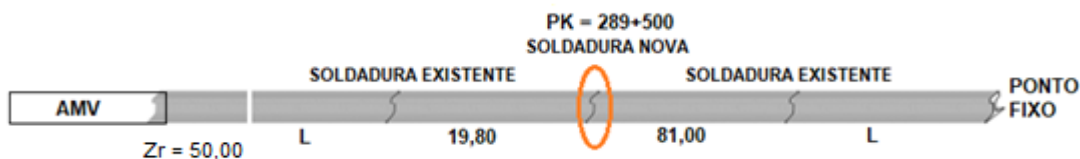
Soldadura no sub-troço R2.1.
